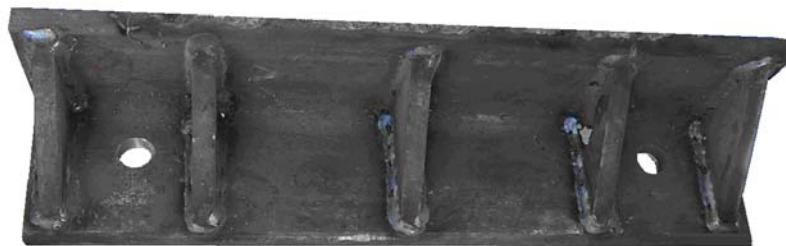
Capitel empleado para refuerzo de nudo con barra vertical
